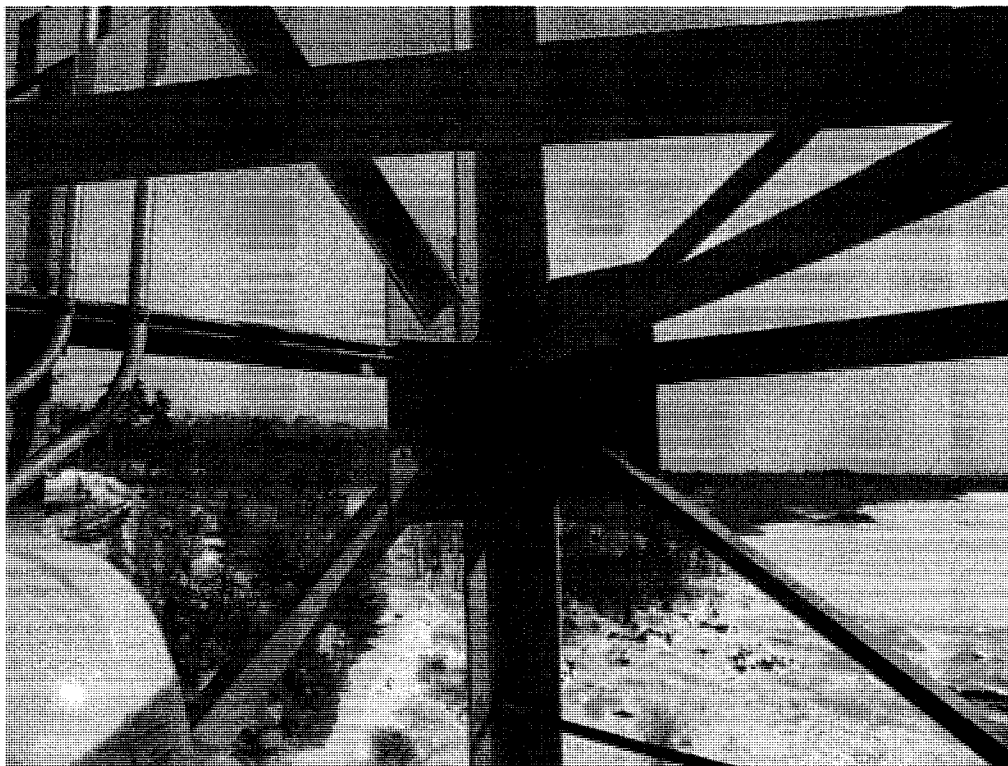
Connexion des diagonales et des poutres de la tour au poteau
